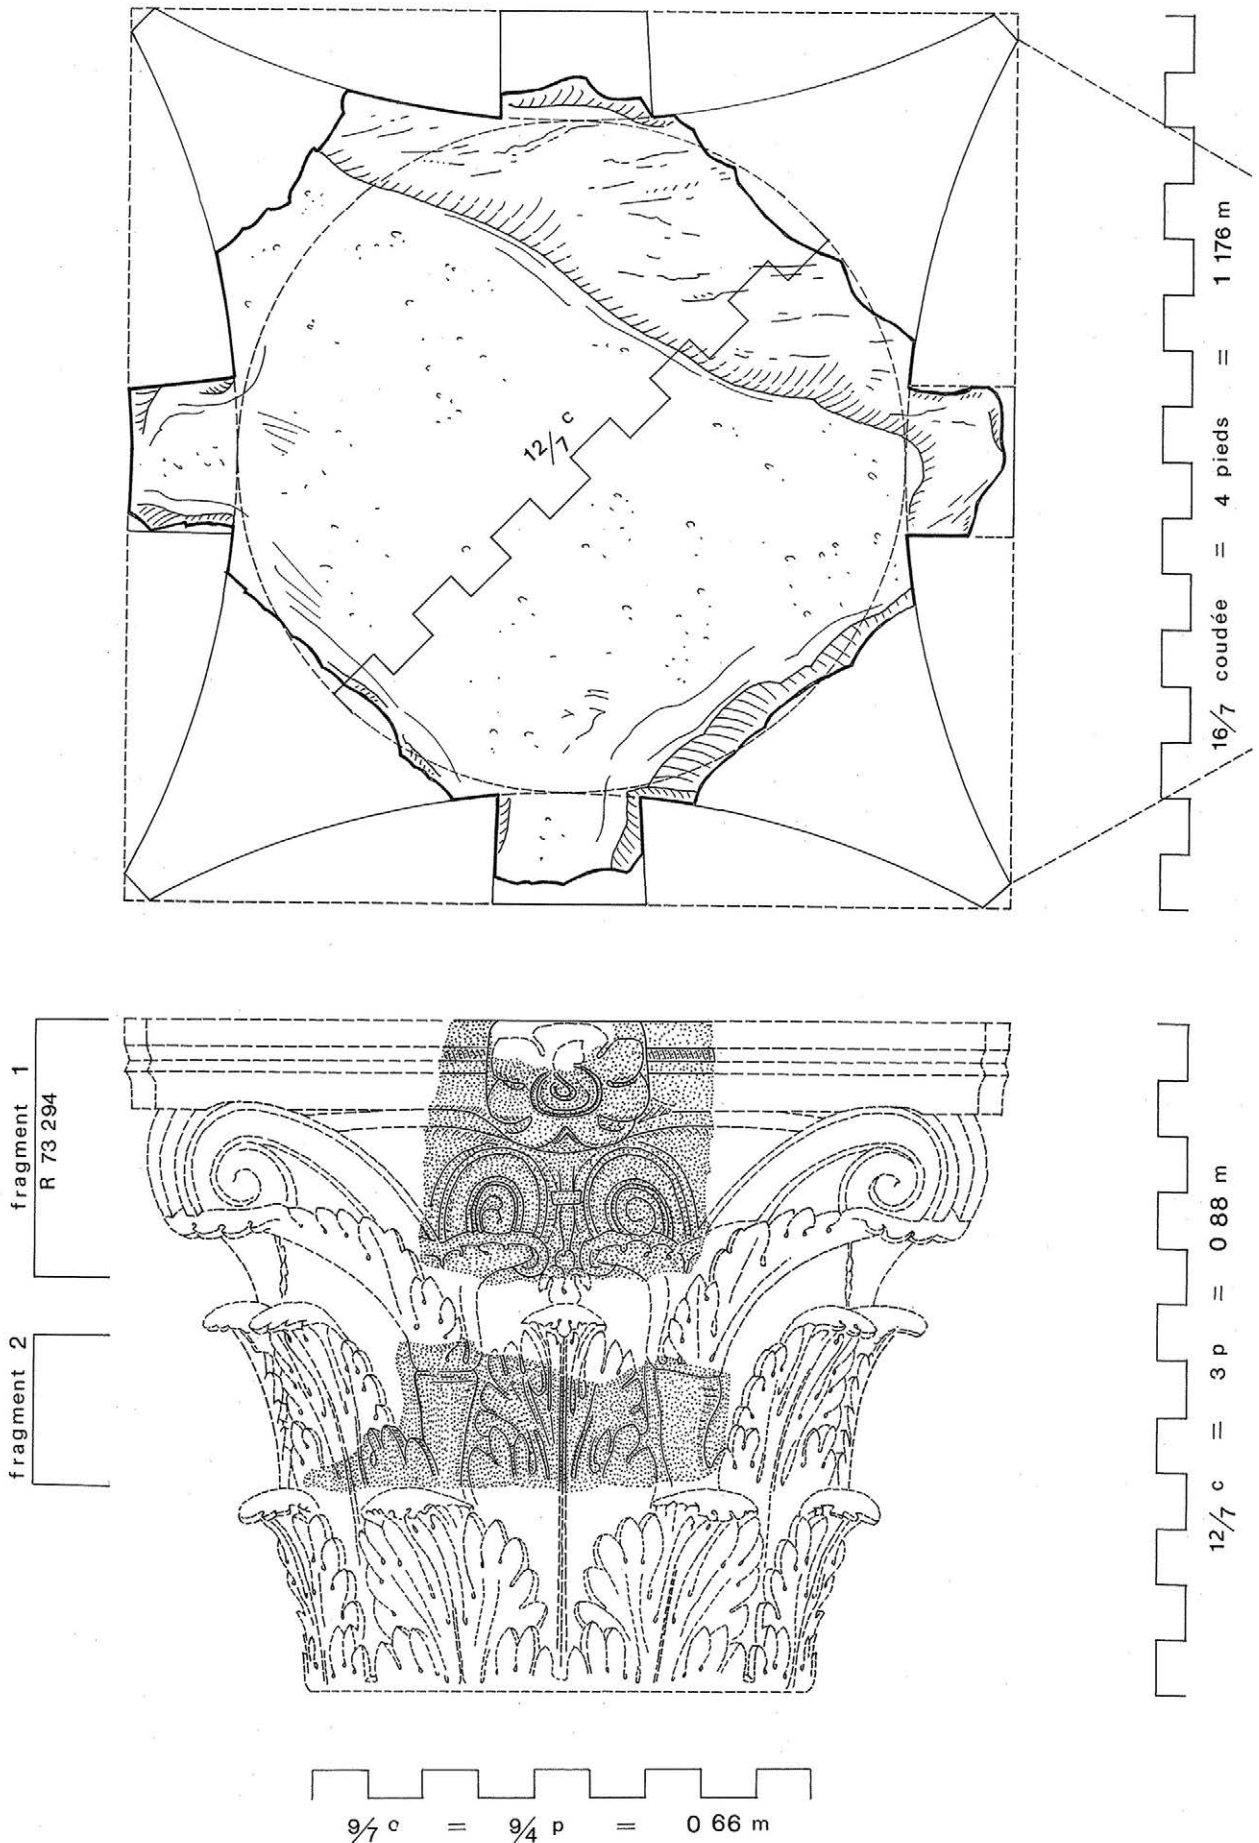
Détail du chapiteau de portique reconstitué : plan du lit d'attente du tailleur et élévation (G. Hallier).
